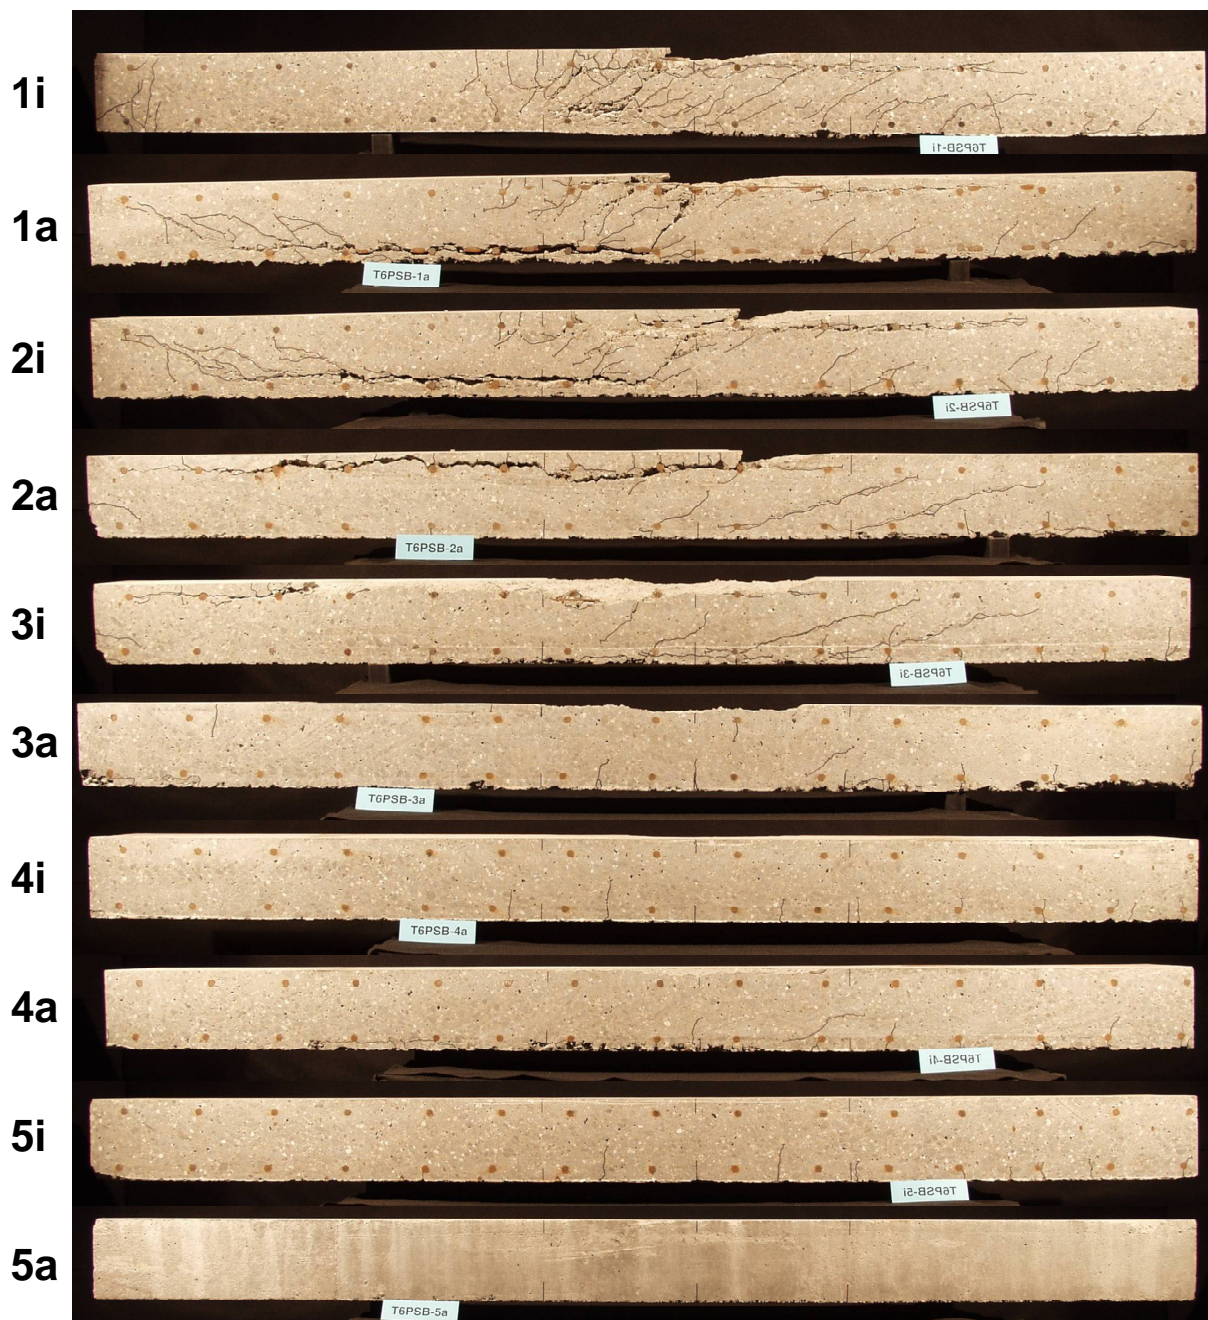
Rissbild auf der linken Betongurtseite
